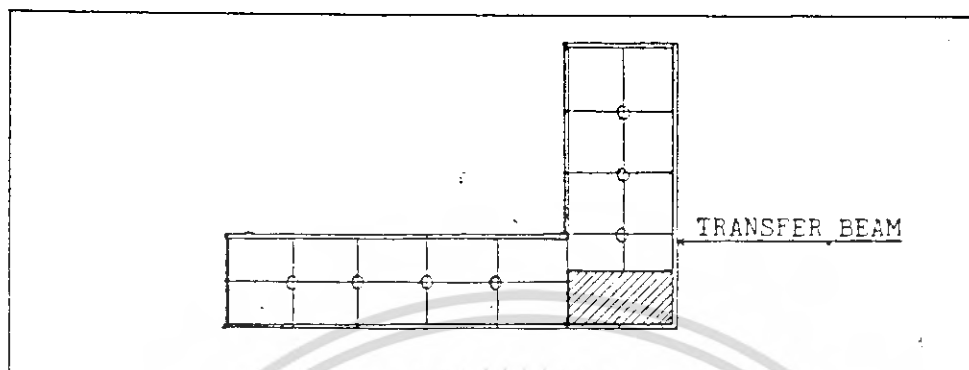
การรวมระบบ FRAME และ SHEAR WALL
